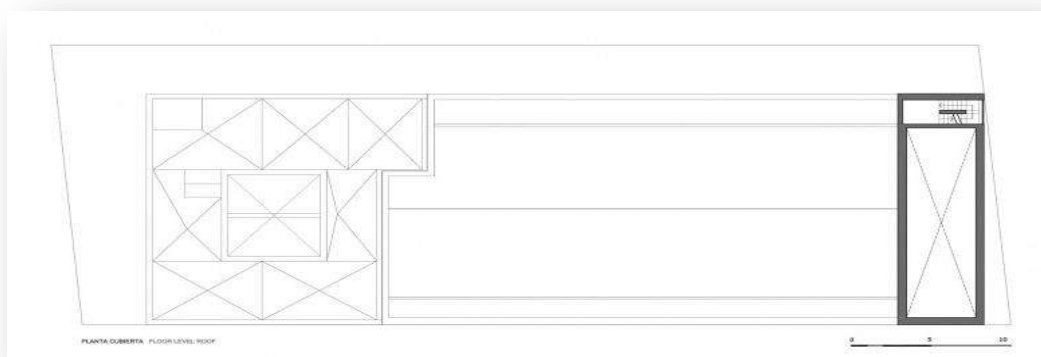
Planta arquitectónica de cubiertas de la parroquia.
